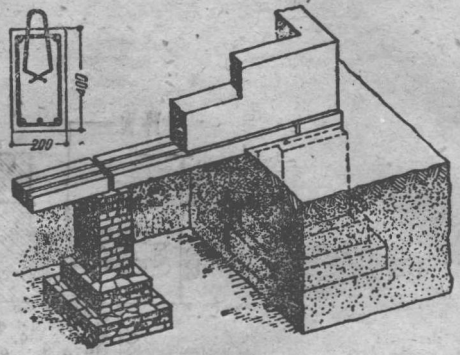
13 墩基用装配式钢筋混凝土基础梁联系
